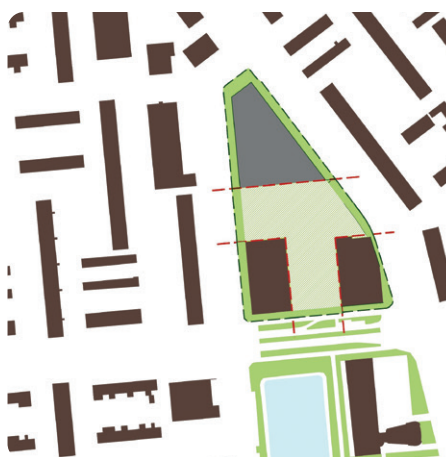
(geel) Schijfvorm op een (rood) plakvormig gebouw
